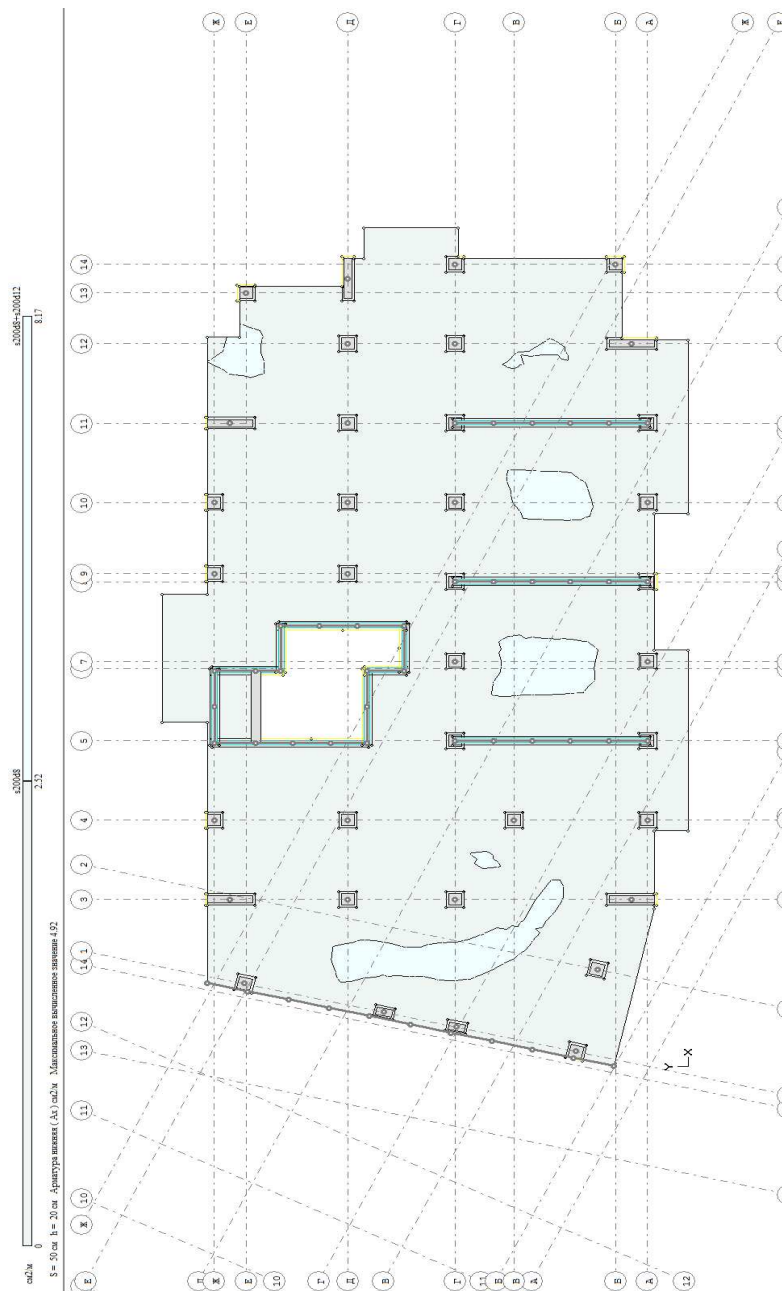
армирования плиты перекрытия типового этажа (толщина плиты 200мм, бетон B25)
